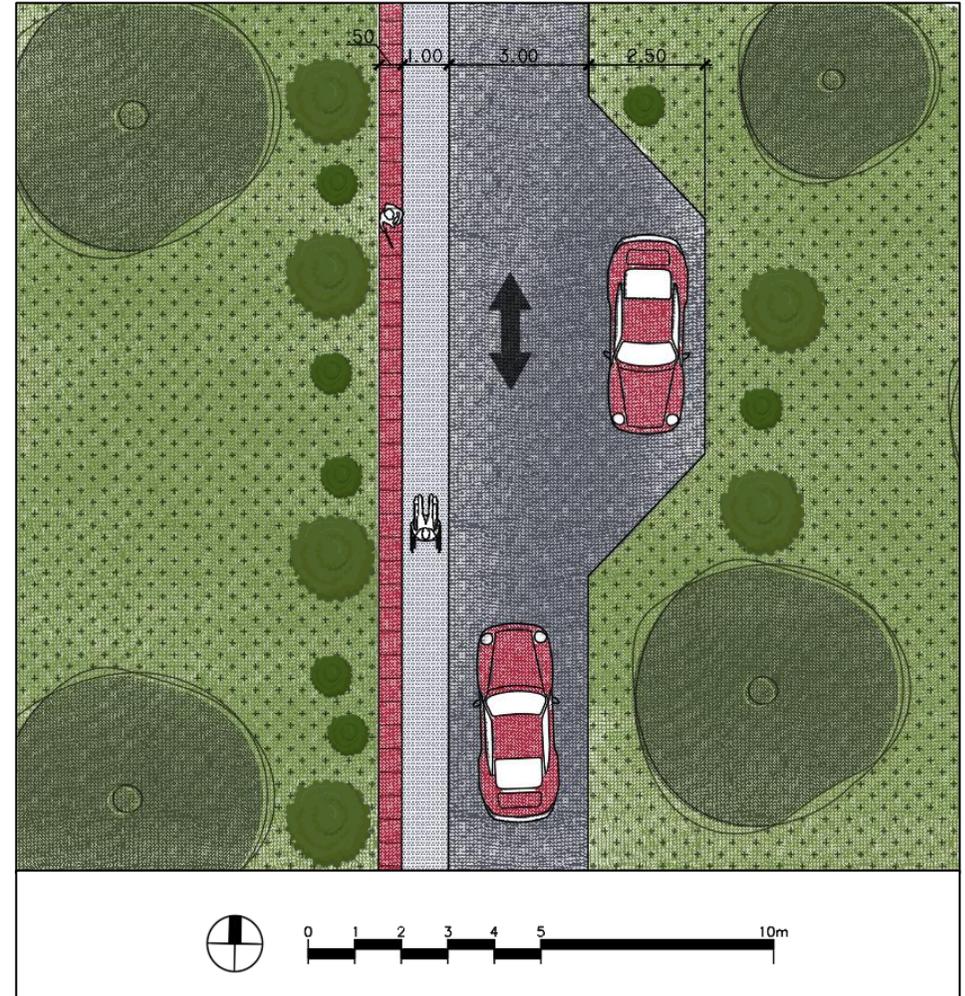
Detalle de plano de propuesta de acondicionamiento de ruta principal.
